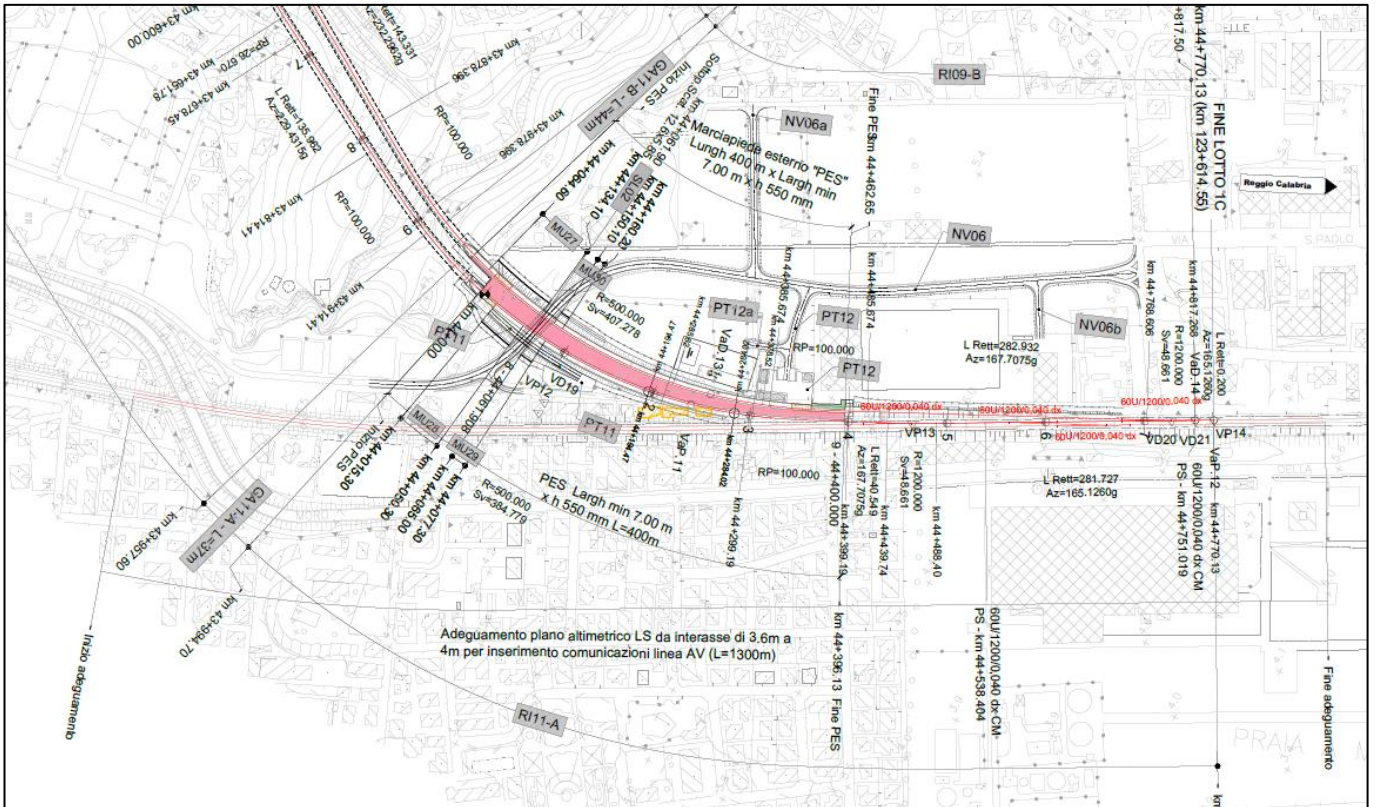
Planimetria in prossimità della stazione di Praia a Mare
